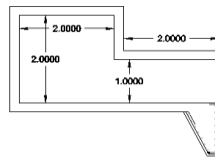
Detalle de la explanación denominada precebo, vista en planta.
